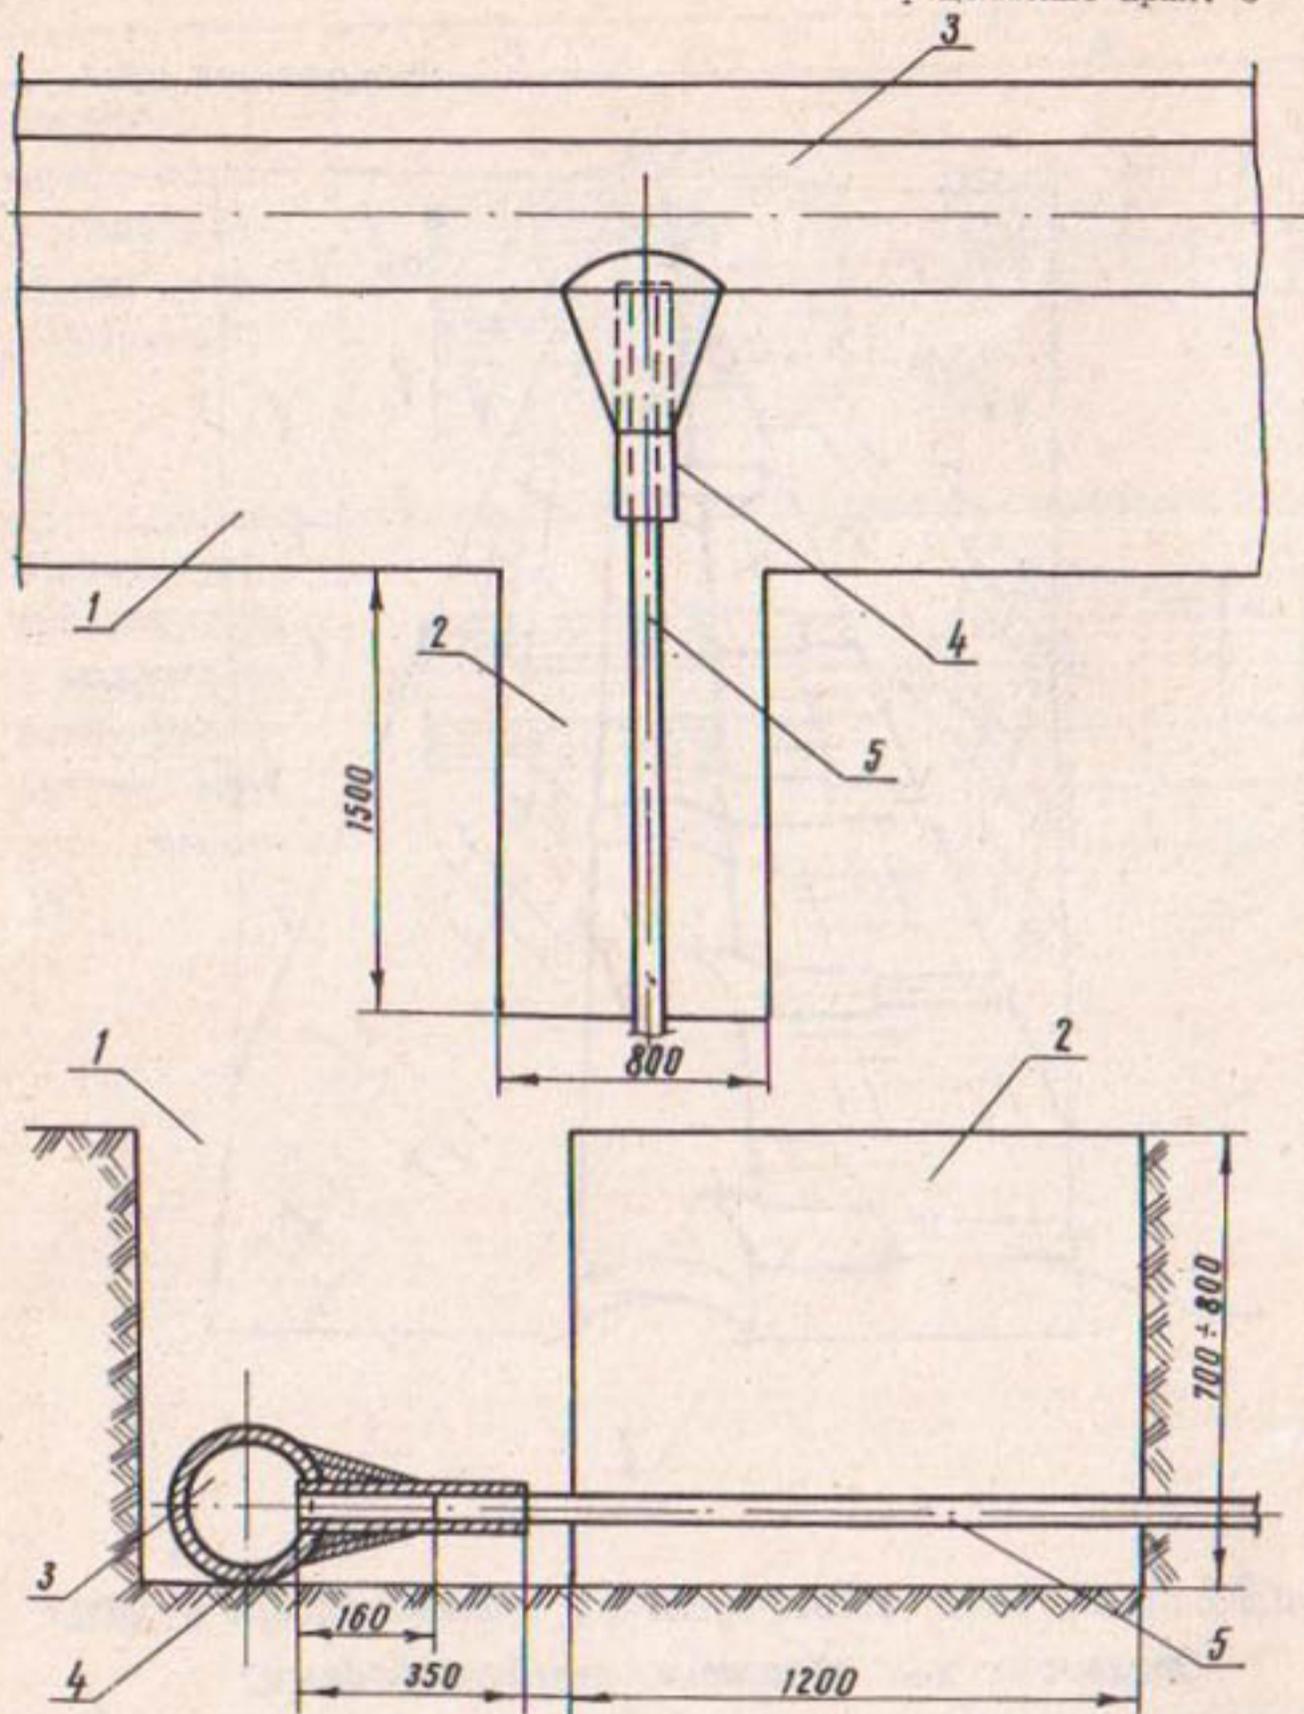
Схема соединения оросительного, сбросного и увлажнительного трубопроводов;
